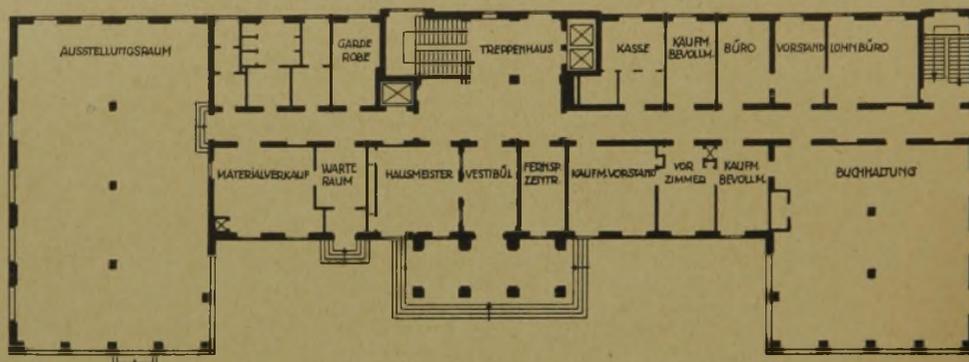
Grundriß des Erdgeschoßes. Maßstab 1:500.
